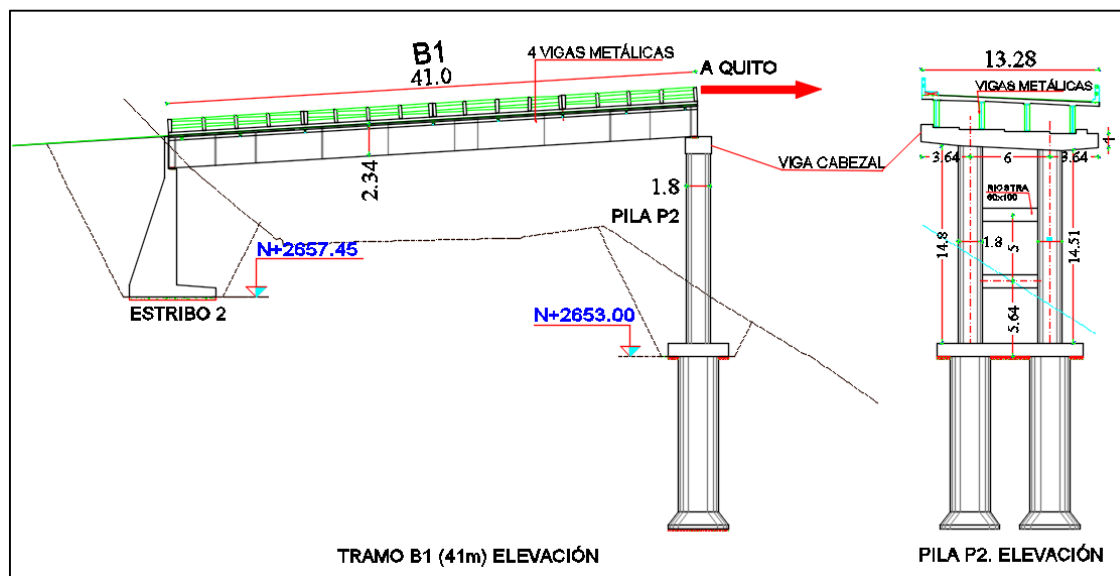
Tramo B1 (41m) y Pila P2 en elevación
